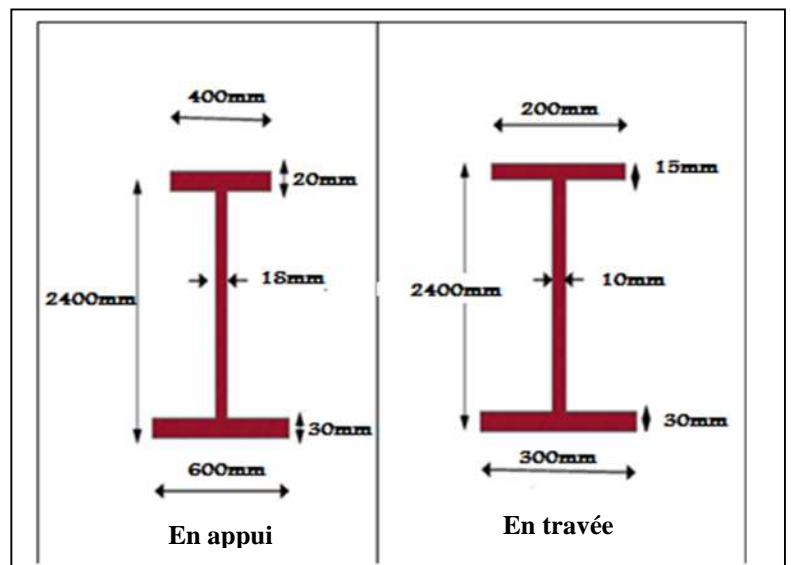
Profilé de poutre à mi-travée et sur appui
